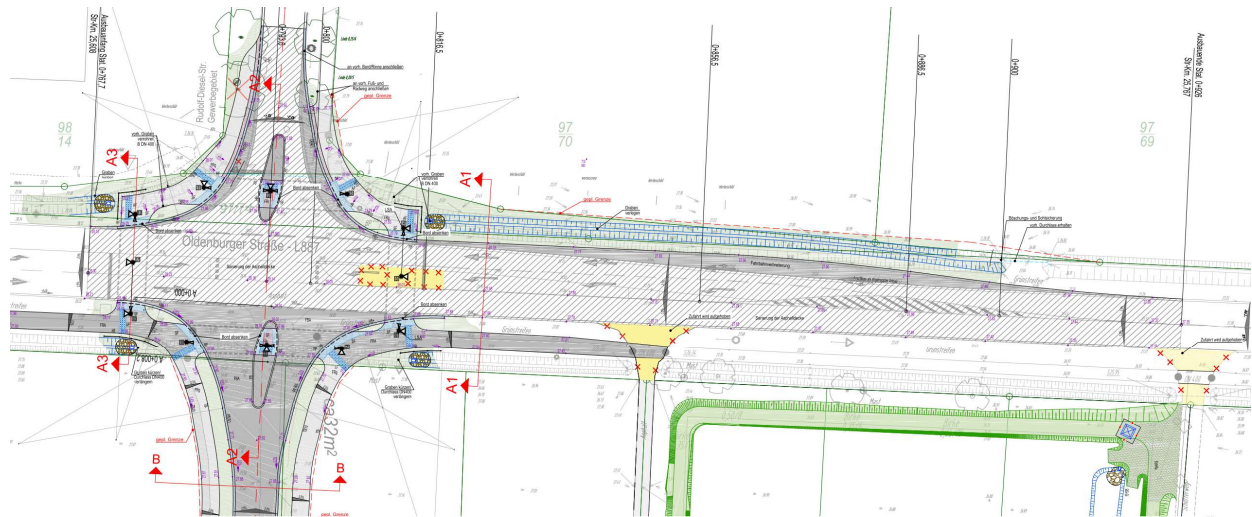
Planungsbüro Gerdes: Gemeinde Ganderkesee: Erschließung des Baugebietes B-Plan Nr. 245 „südl. Oldenburger Straße/ Ramsauerweg; Ausführungsplanung, Oldenburg, 17.12.2018
